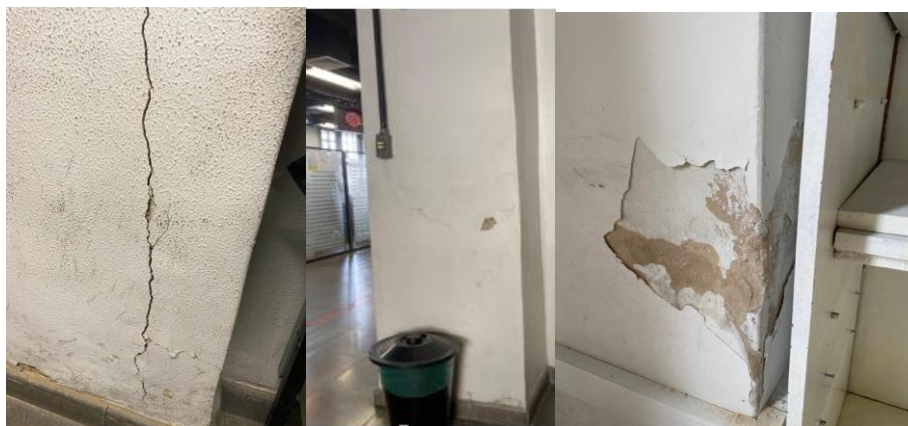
Pilar localizado no pavimento térreo; Foto 2 – Pilar localizado no primeiro pavimento; e Foto 3 – Pilar localizado no terceiro pavimento
